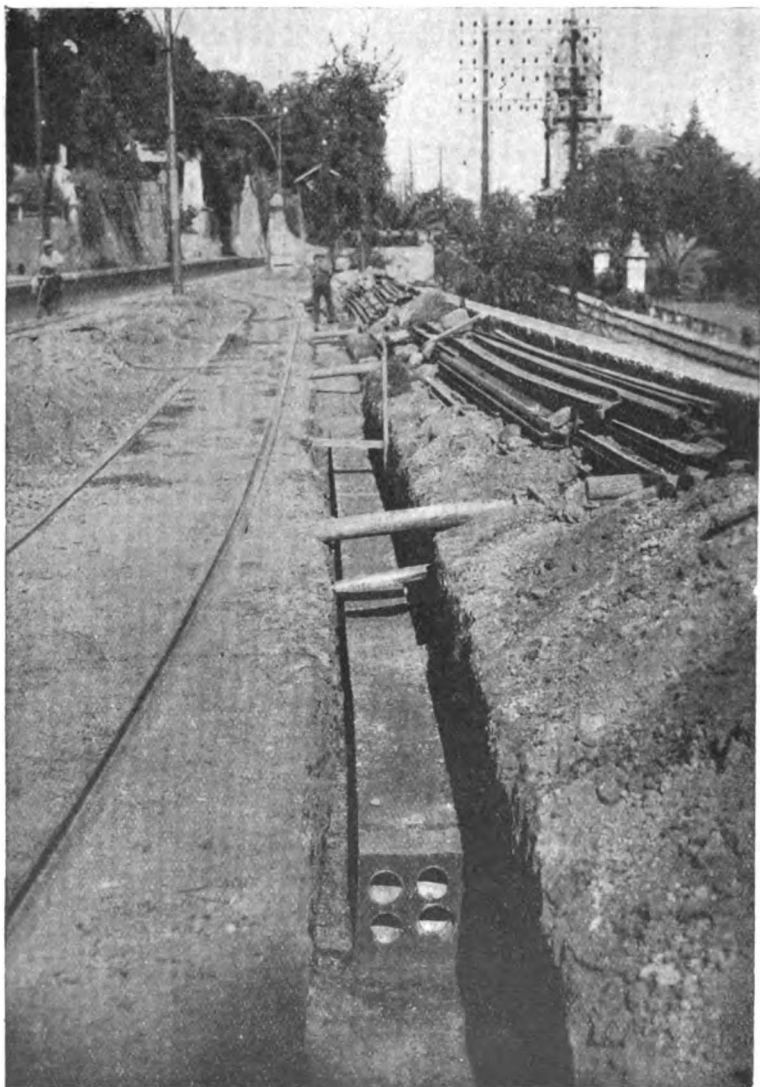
Pose d'une conduite monolithe : vue de la conduite après décoffrage.
